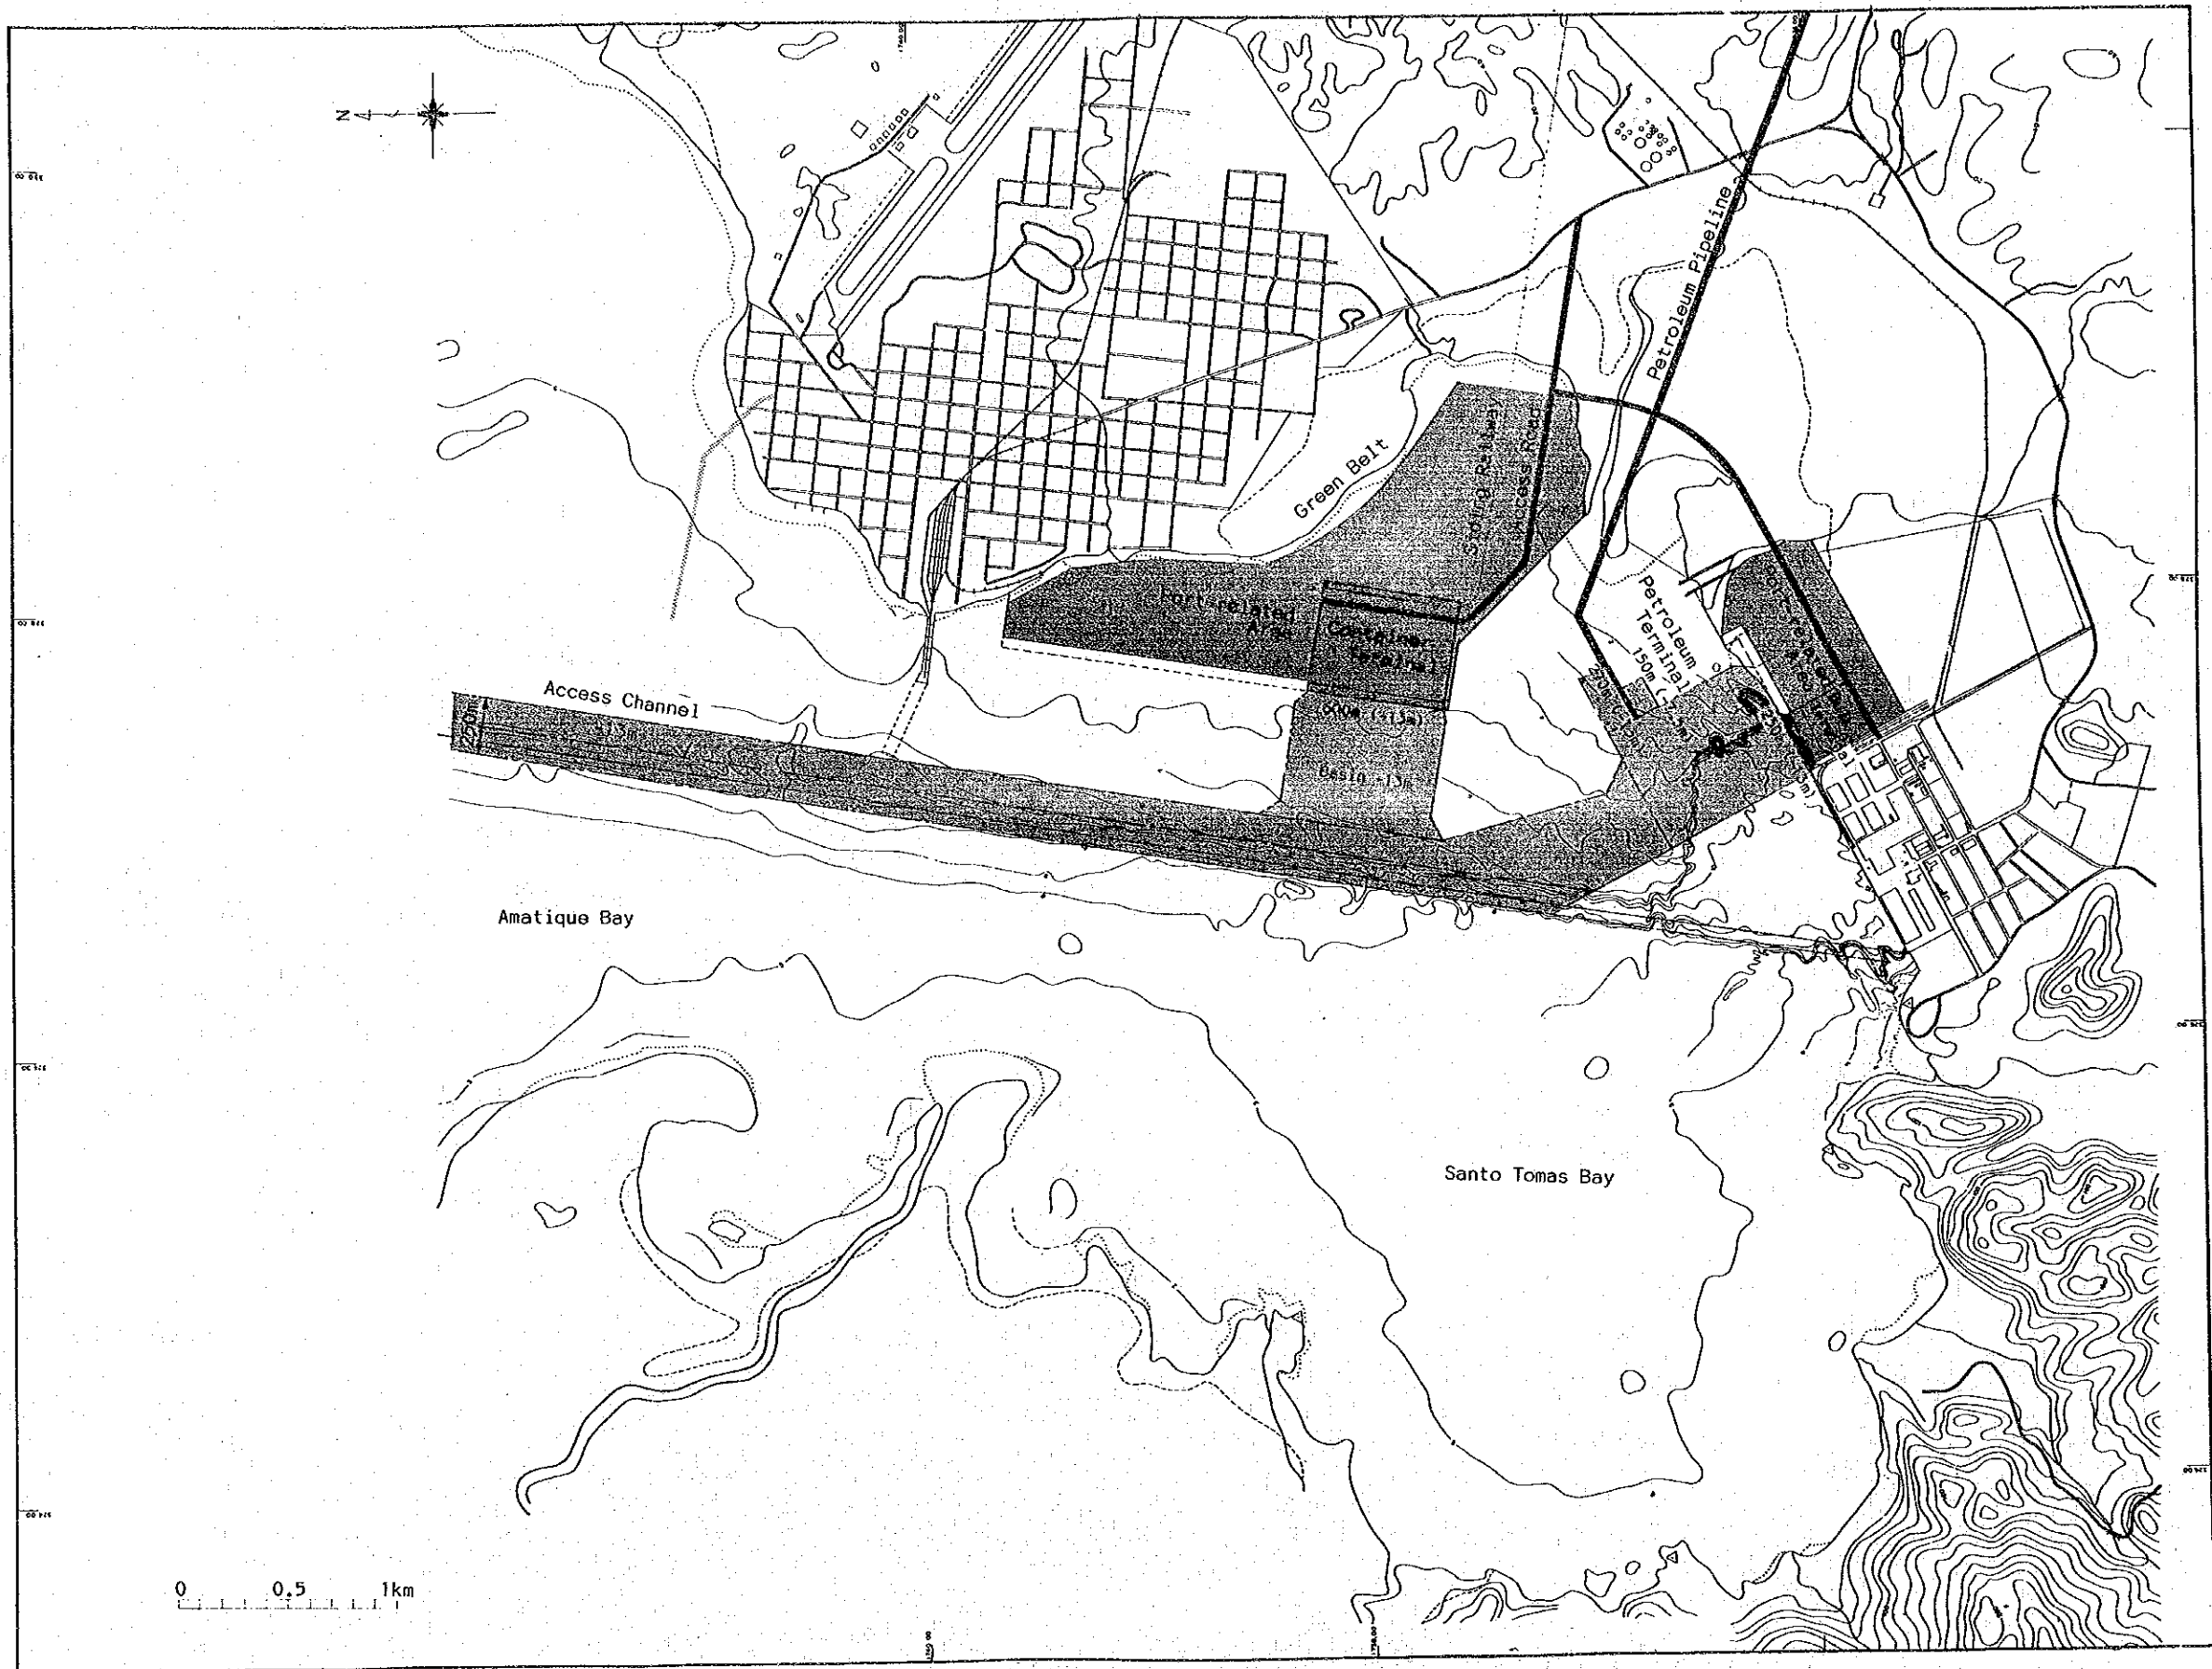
Plan Alternativo de Distribución ---Caso 2
